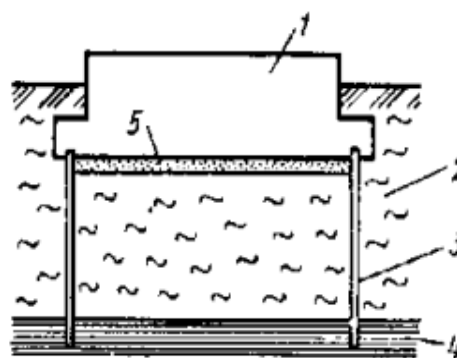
Усиление основания с помощью шпунтового ограждения: 1 – фундамент; 2 – слабый грунт; 3 – шпунтовое ограждение; 4 – плотный грунт; 5 – песчаная подушка (дренирующий слой).
